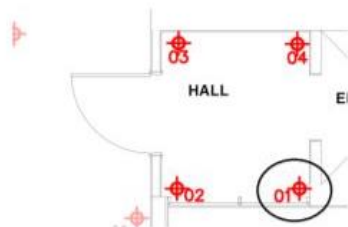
Ponto 1 no projeto de planta de mapeamento
